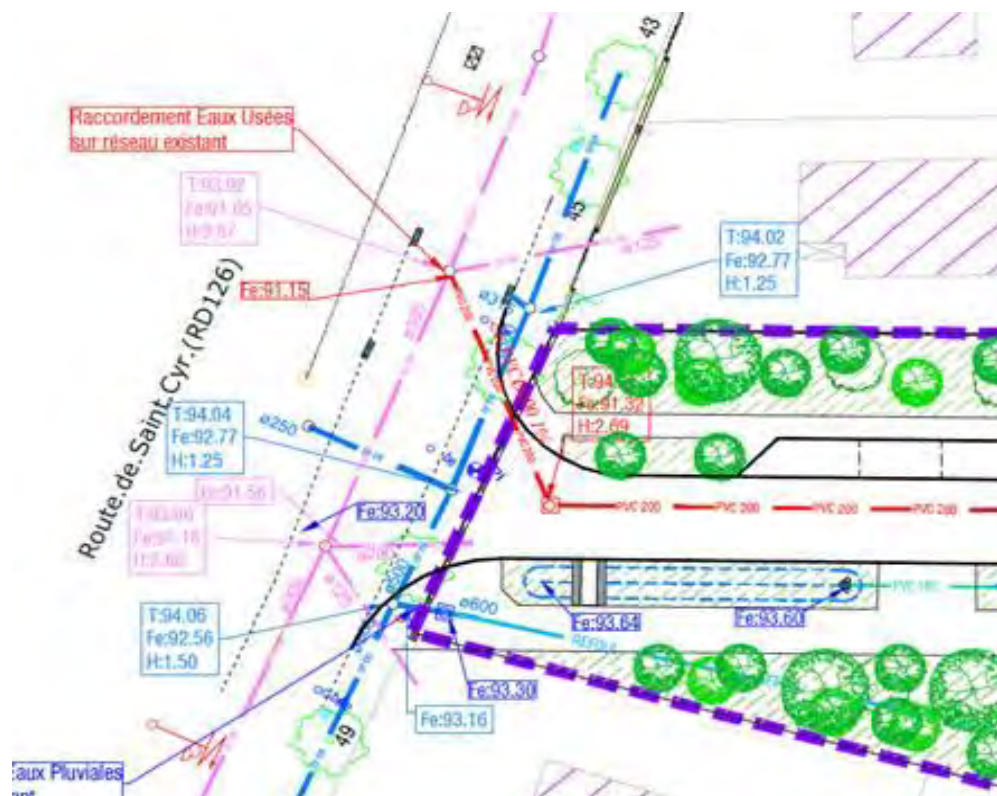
Extrait de plan du réseau eaux pluviales - Source : Orling
